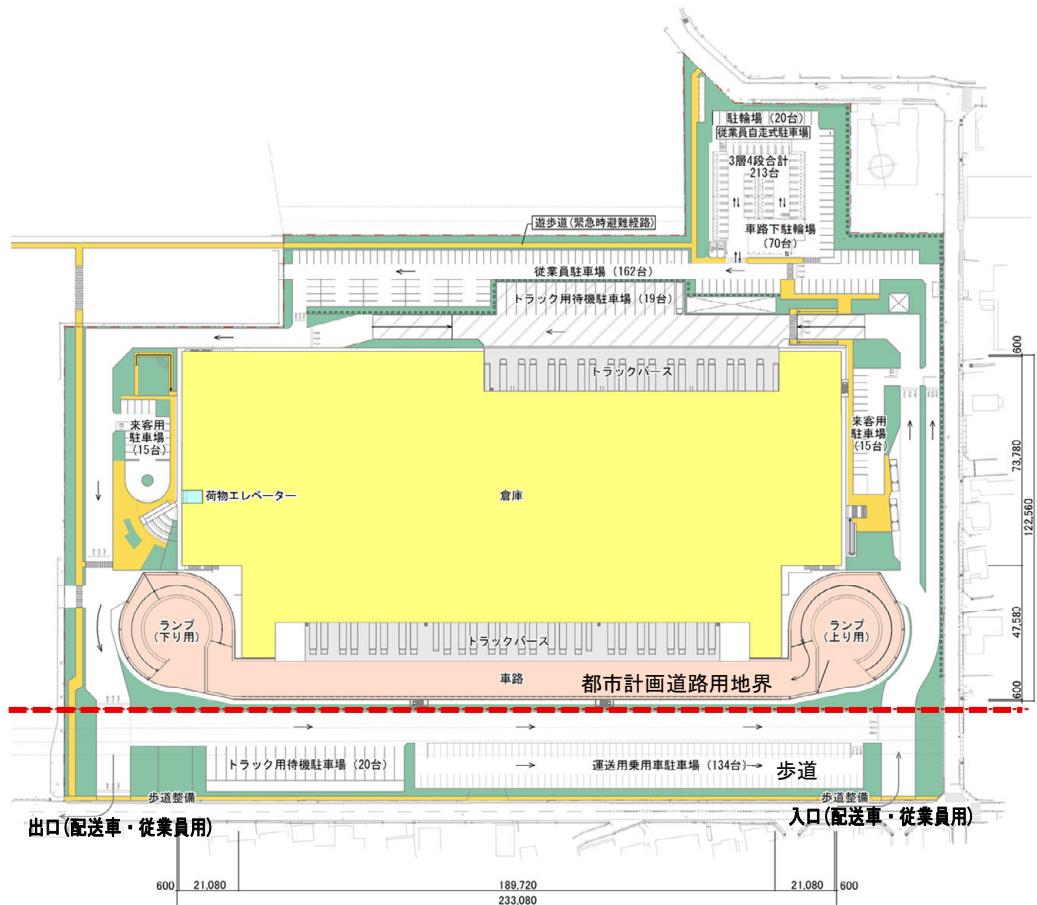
(2) 配置計画図兼 1 階平面図【変更後】
